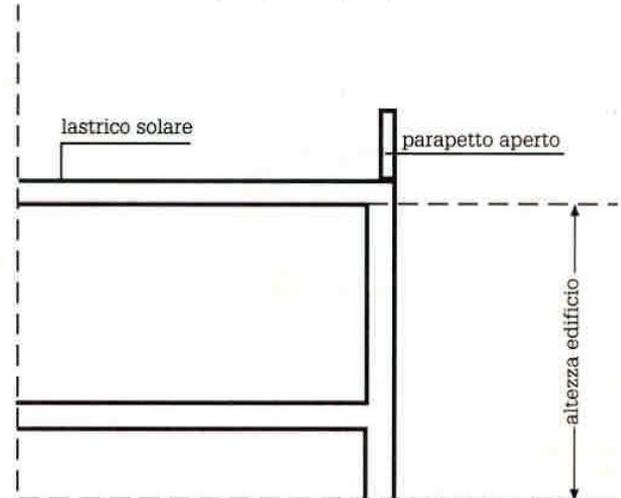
Edificio con copertura piana, parapetto aperto e lastrico solare
